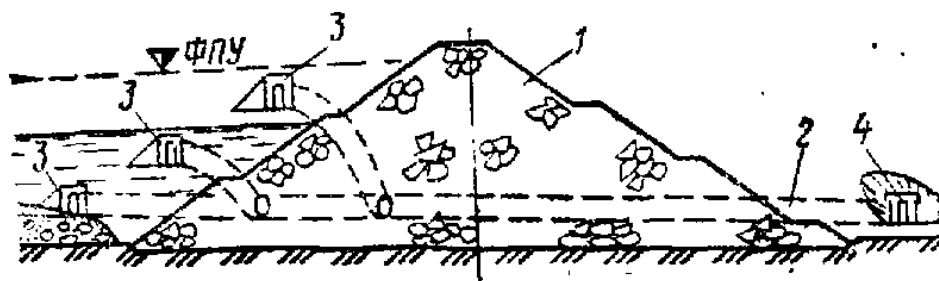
Гидрозел селехранилища с каменно-набросной (или завальной) плотиной и туннельным водосбросом: 1 – грунтовая плотина; 2 – водосбросный тракт; 3 – вход в водосброс; 4 – выход.
